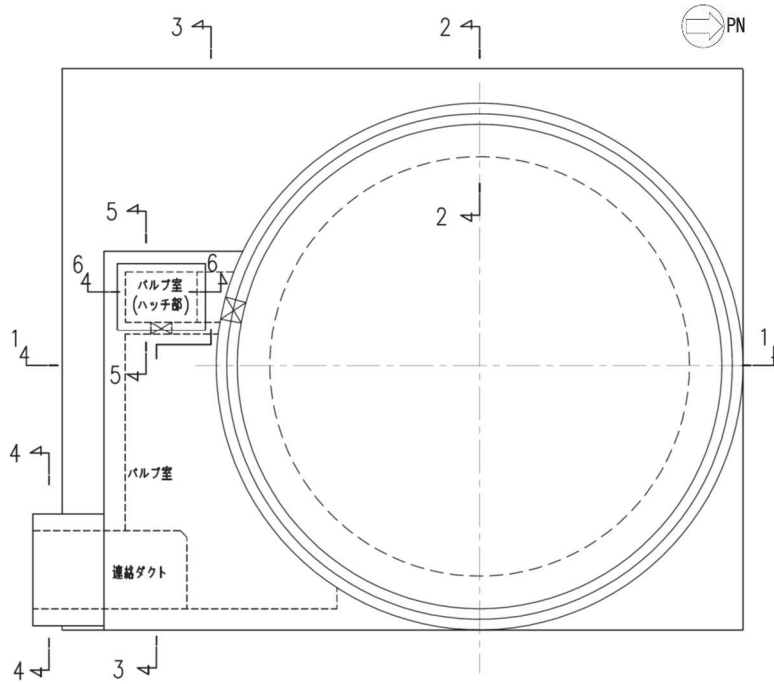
復水貯蔵タンク基礎 概略配筋図 (平面図)
